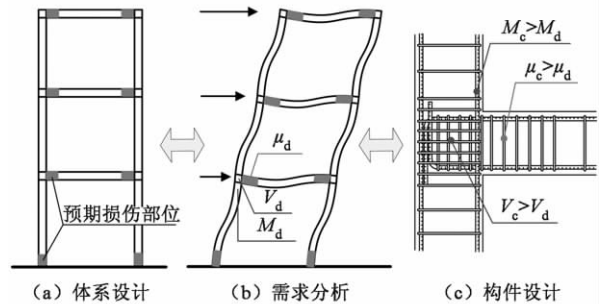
钢筋混凝土结构抗震损伤机制控制的基本内容
